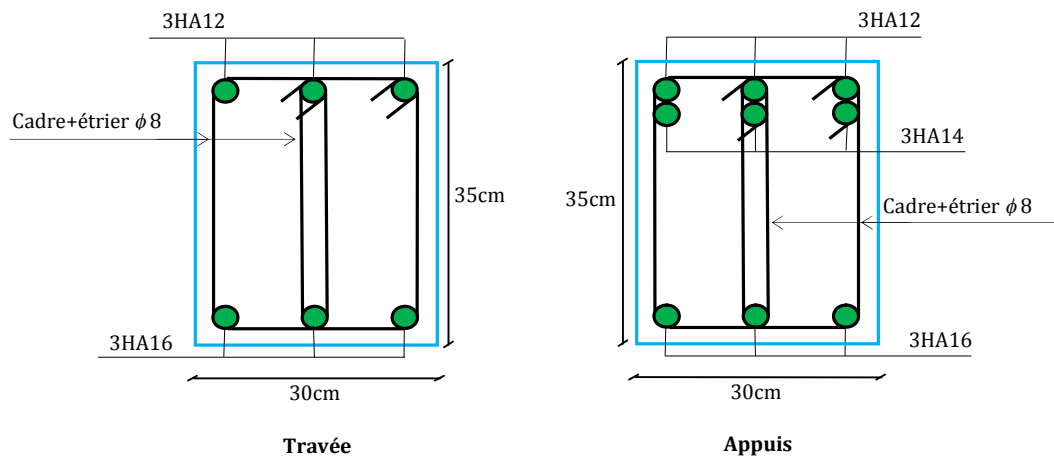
Schéma de ferrailage des poutres secondaires de 1^{er}, 2^{eme}, 3^{eme} et 4^{eme} étages.
